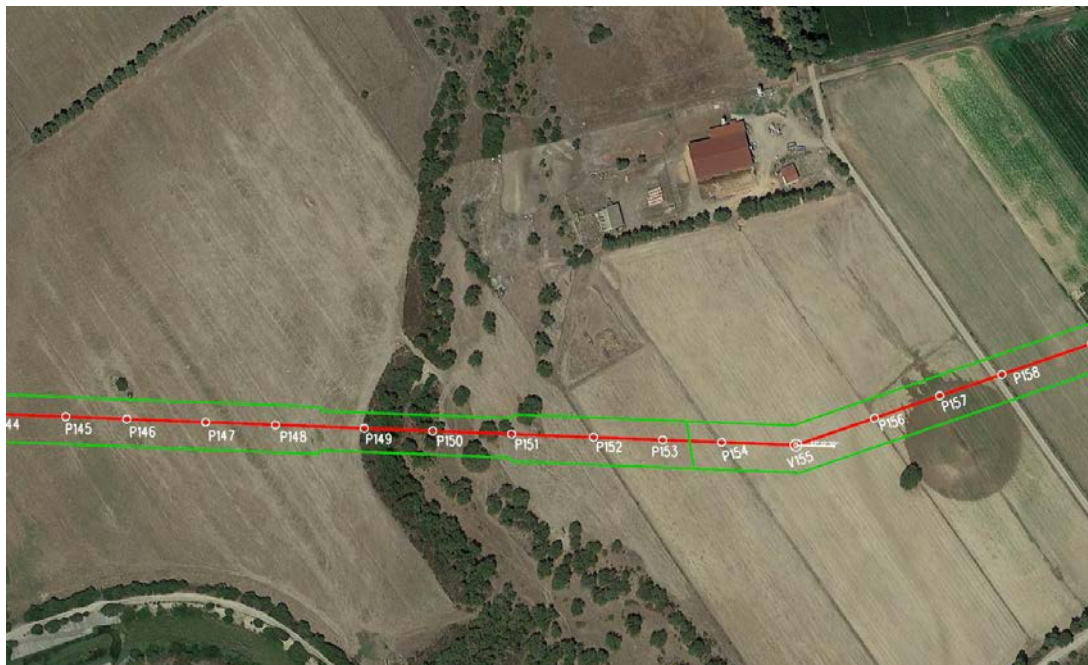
Tratto P149 - P151 - la zona delimitata dalle linee verdi rappresenta la fascia ristretta di lavoro per come previsto dalla GASD C 13.40.10.02
